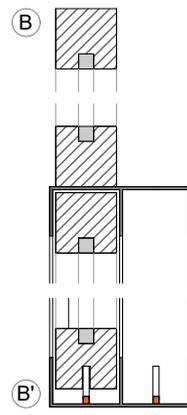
Pormenor construtivo vertical de B a B' - 1/5
